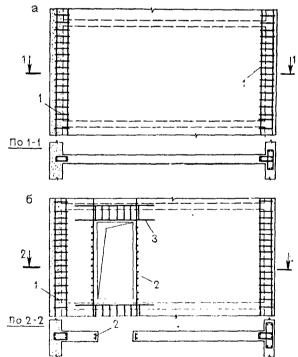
Схемы конструктивного армирования монолитных внутренних стен для обычных условий строительства
